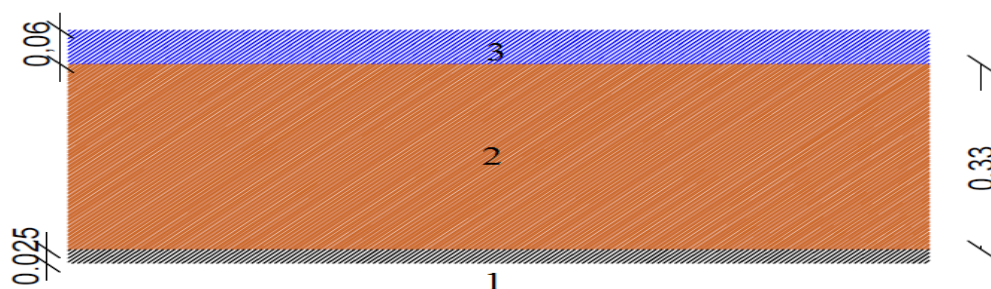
Solução construtiva da cobertura do Edifício B – laje de separação entre o sótão não habitável e a zona útil
